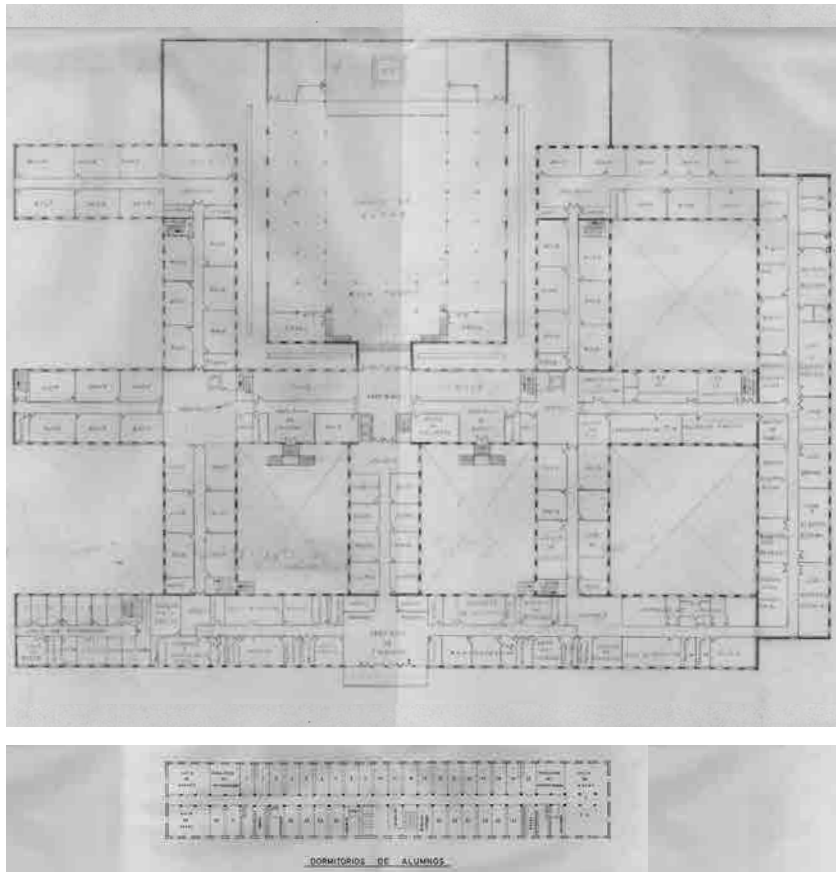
y Fig. 8 Planta principal o de acceso (arriba) y planta octava de dormitorios (abajo).
